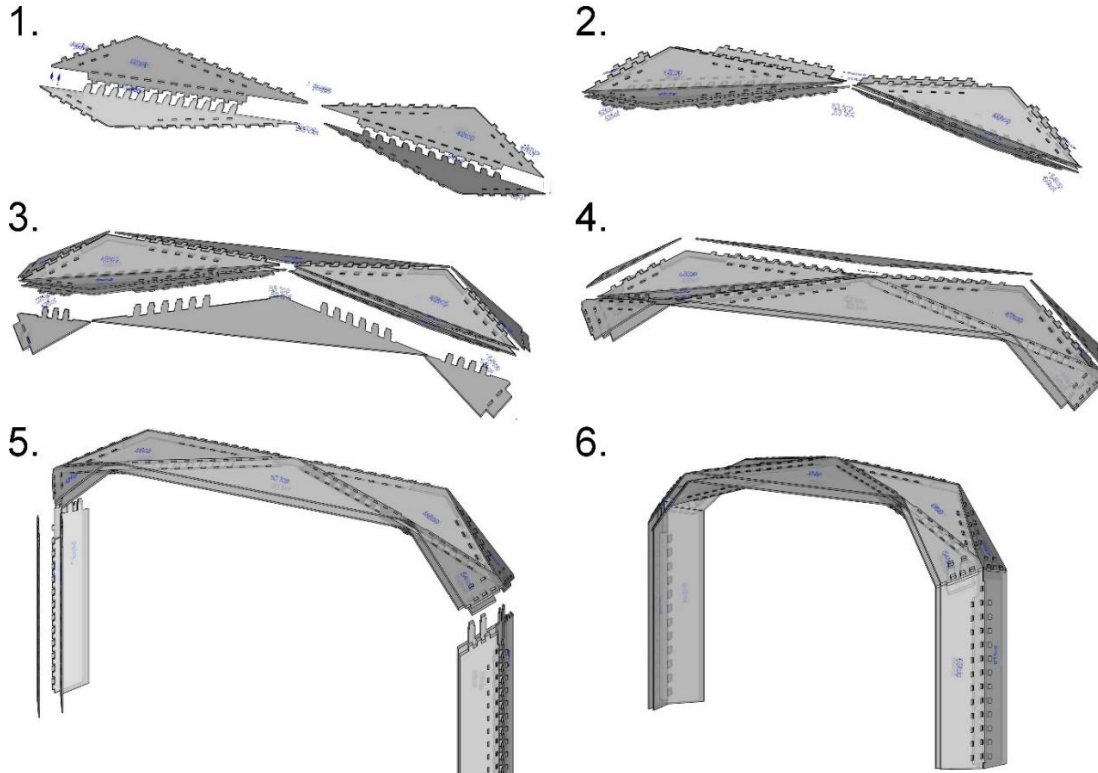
Principe de construction et de montage d'une arche avec les assemblages bois/bois développés
